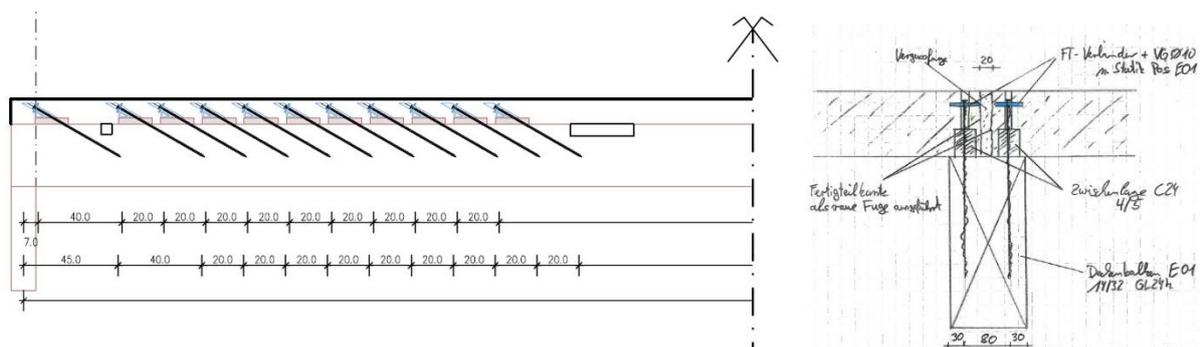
Konstruktionsplan Decke und Schubdetail Deckenstoß
